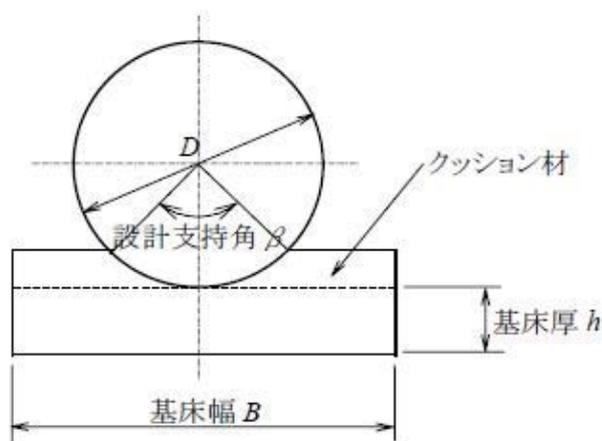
断面たわみ性の円形管体の設計支持角 β
